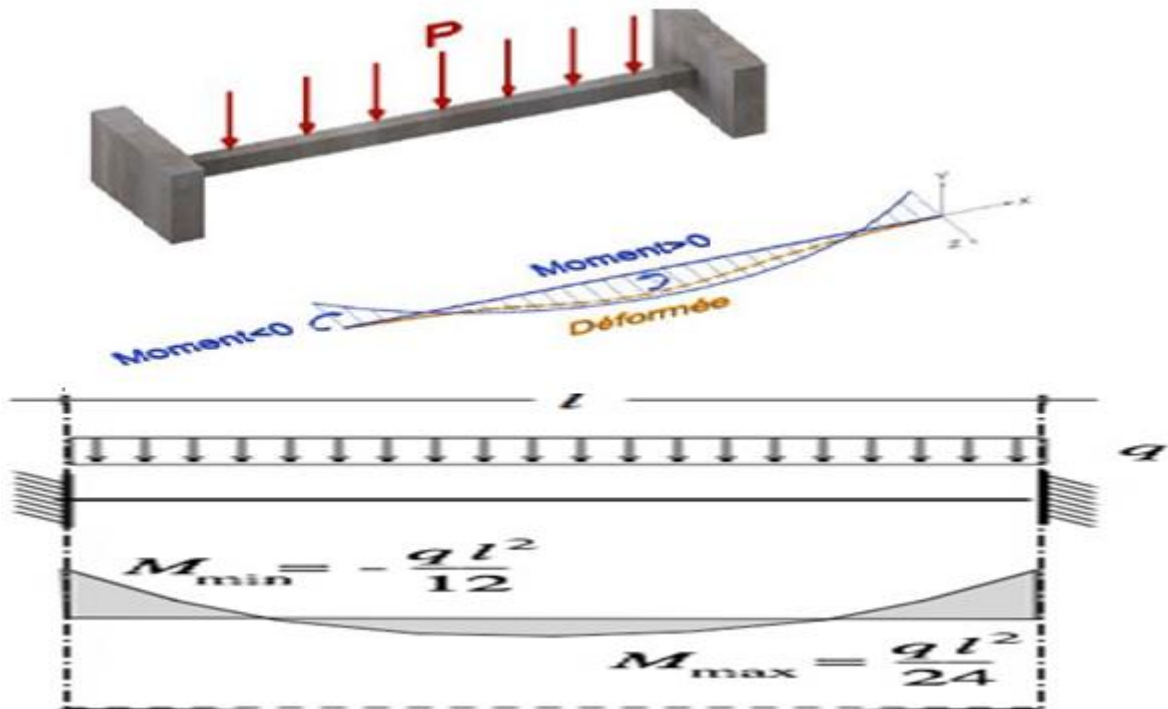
Comportement d'une poutre bi-encastée
